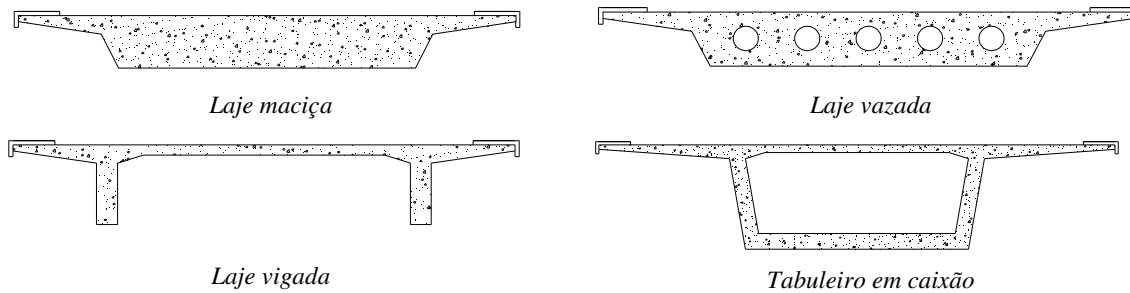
Diferentes tipos de secção transversal de pontes em betão armado
